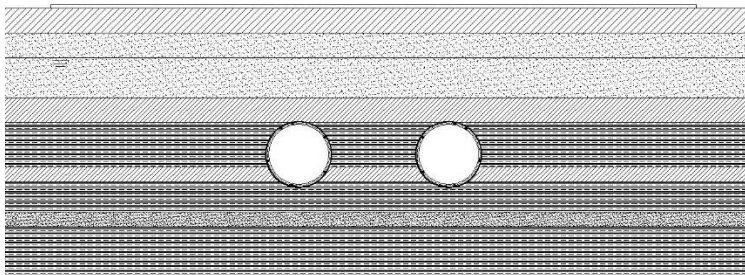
17. *Grouting* Beton Terowongan *Downtrack
